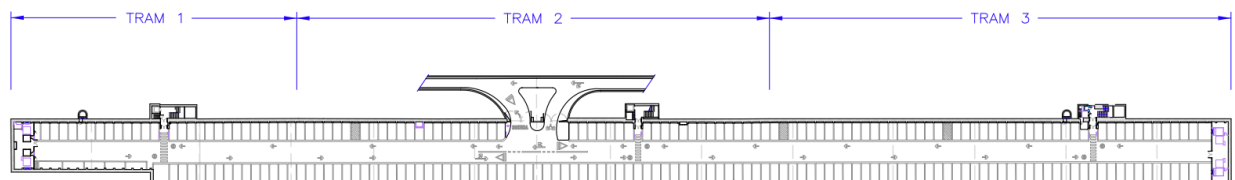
Croquis de situació de la planta soterrani PS-4.
